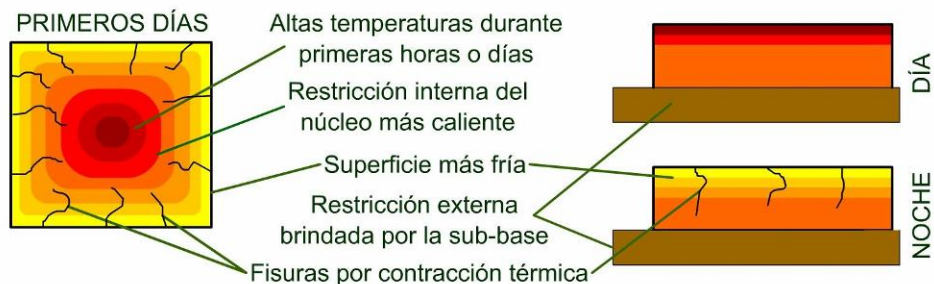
Casos de fisuras por contracción térmica (a la derecha el caso de pavimentos).
